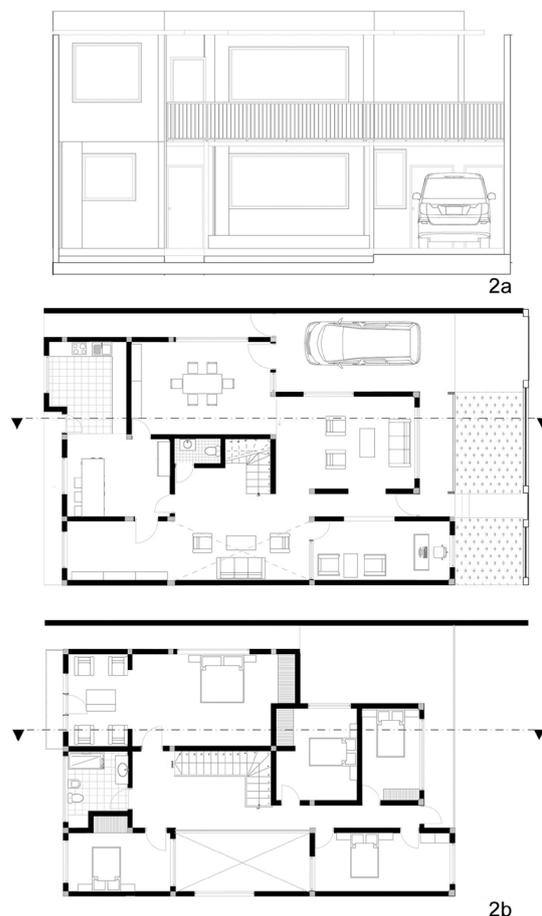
Elevación y plantas arquitectónicas casa Argudo.
